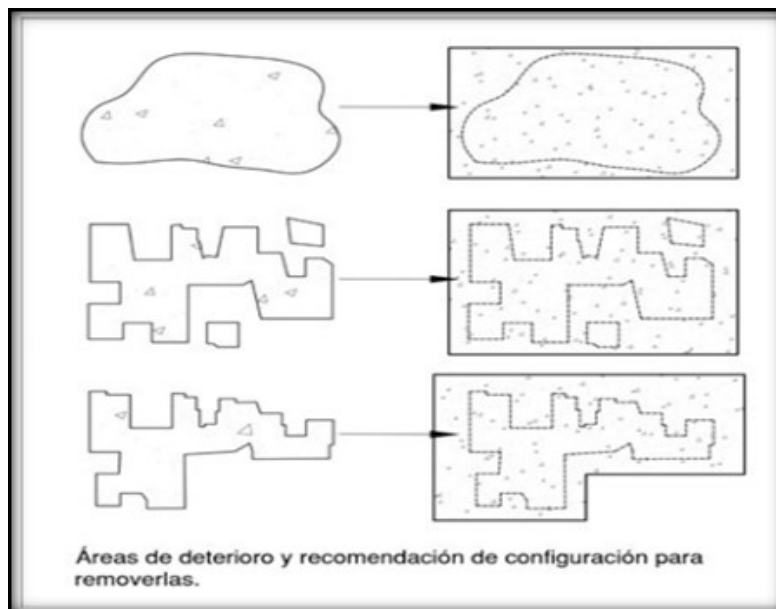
Áreas de deterioro y recomendación de configuración para removerlas. Fuente: Constructora Colpatría
